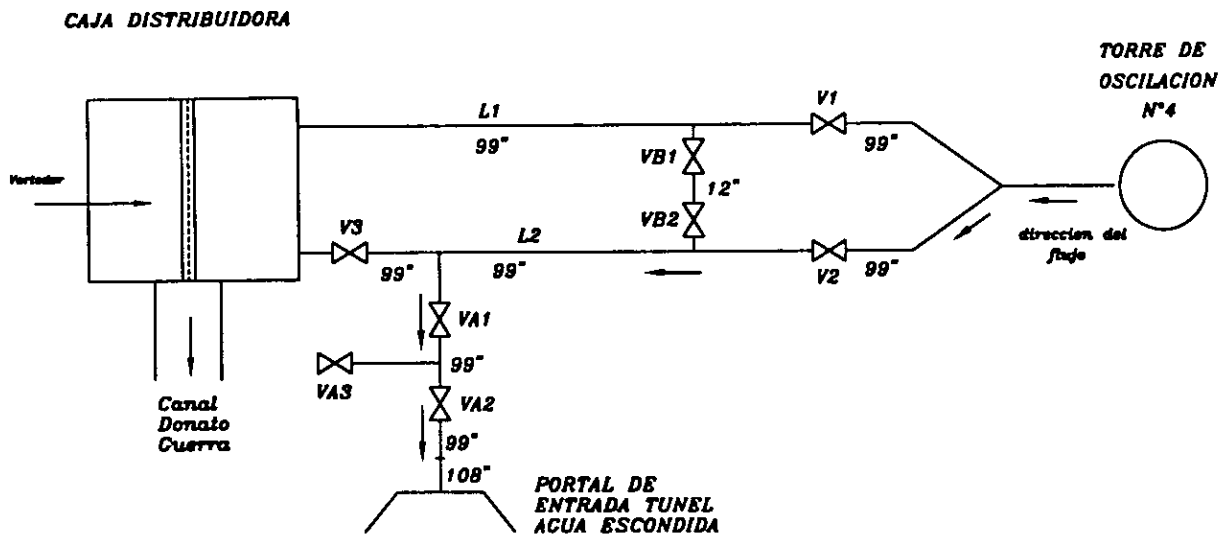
Planta de la línea alterna del Sistema Cutzamala
